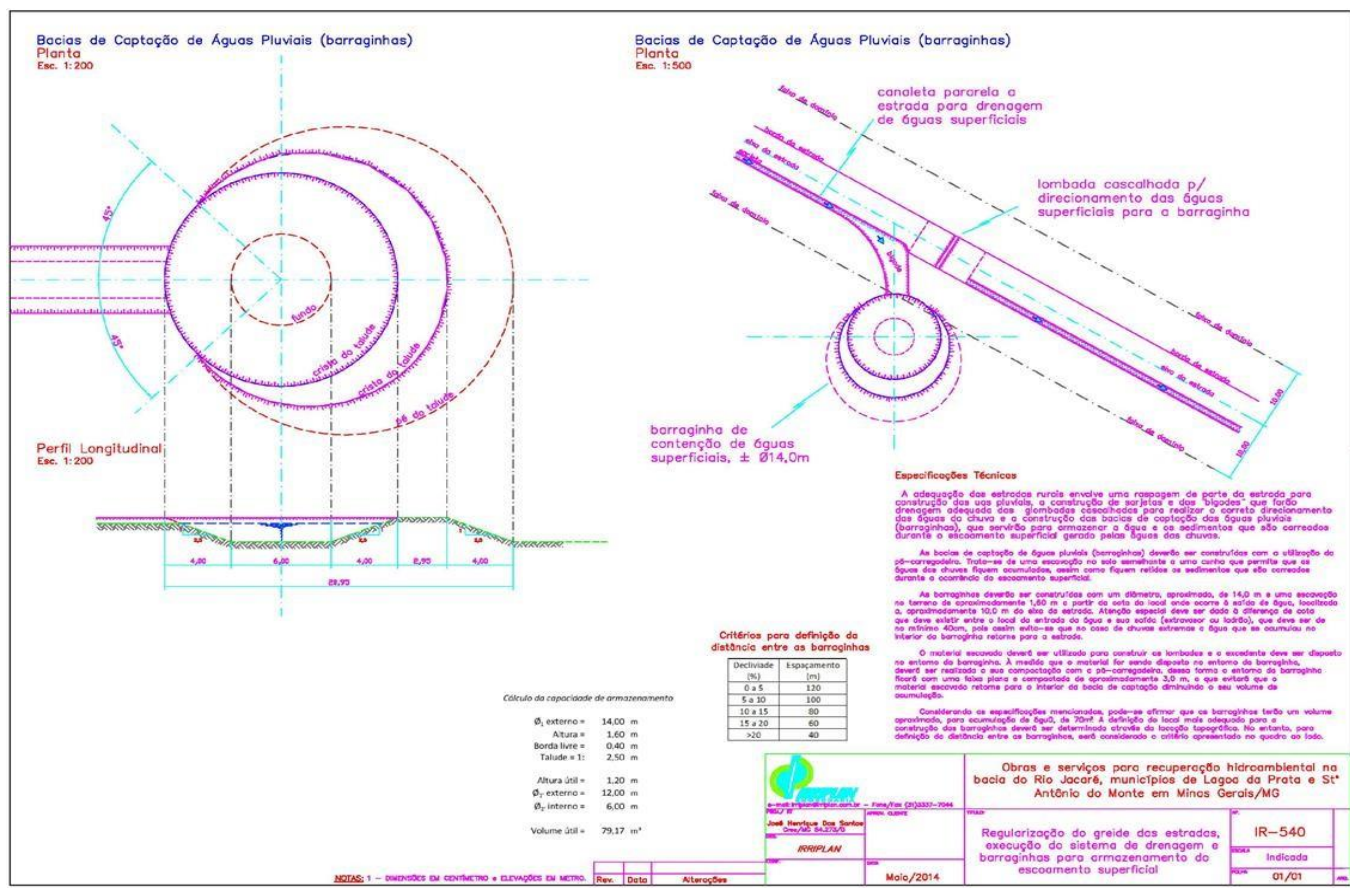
Layout com especificações técnicas para a construção de bacias de captação para drenagem de estradas rurais
